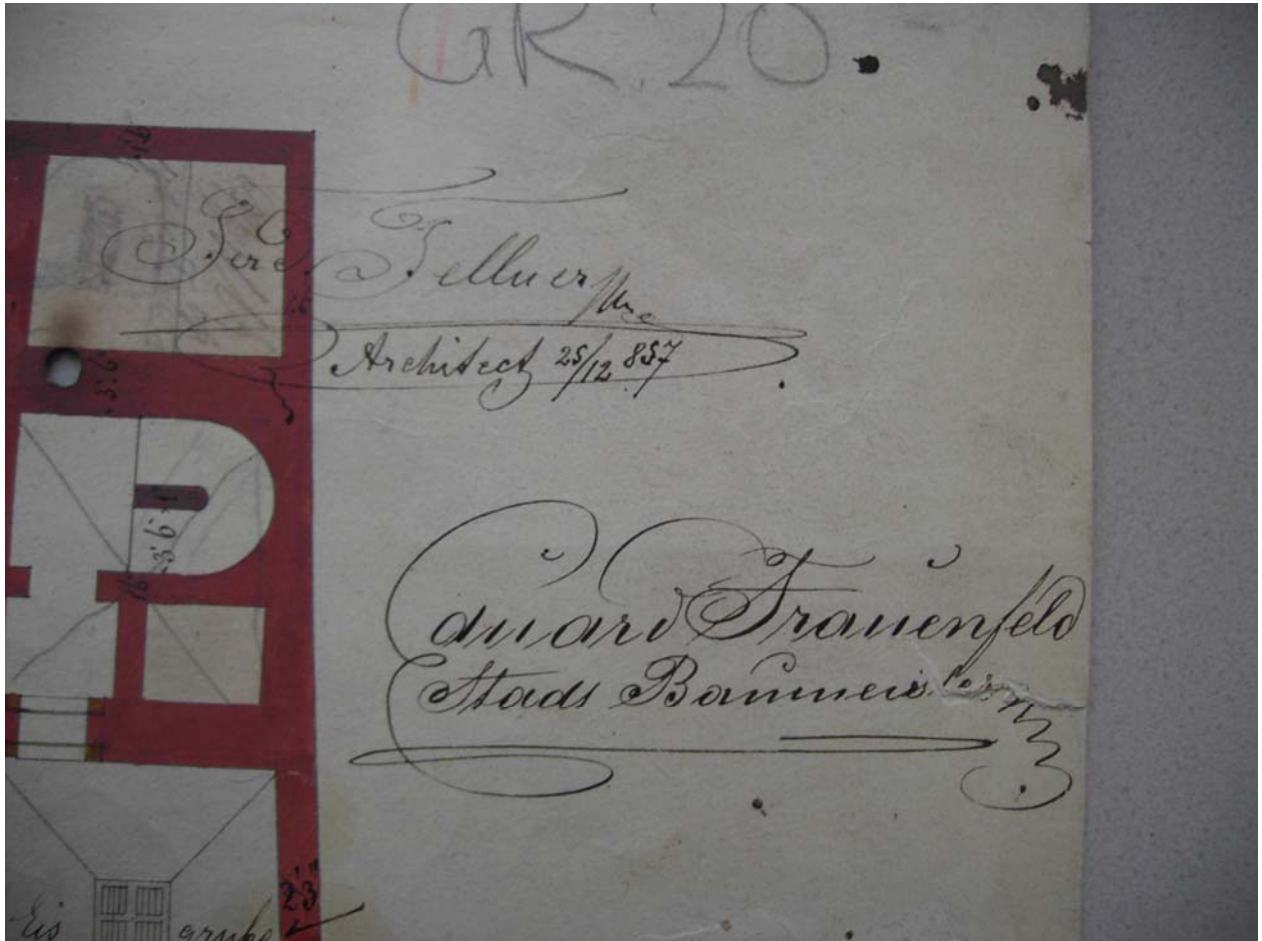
Einreichplan zum Haus Liebieg, 28. 11. 1857, Detail: Signaturen.
